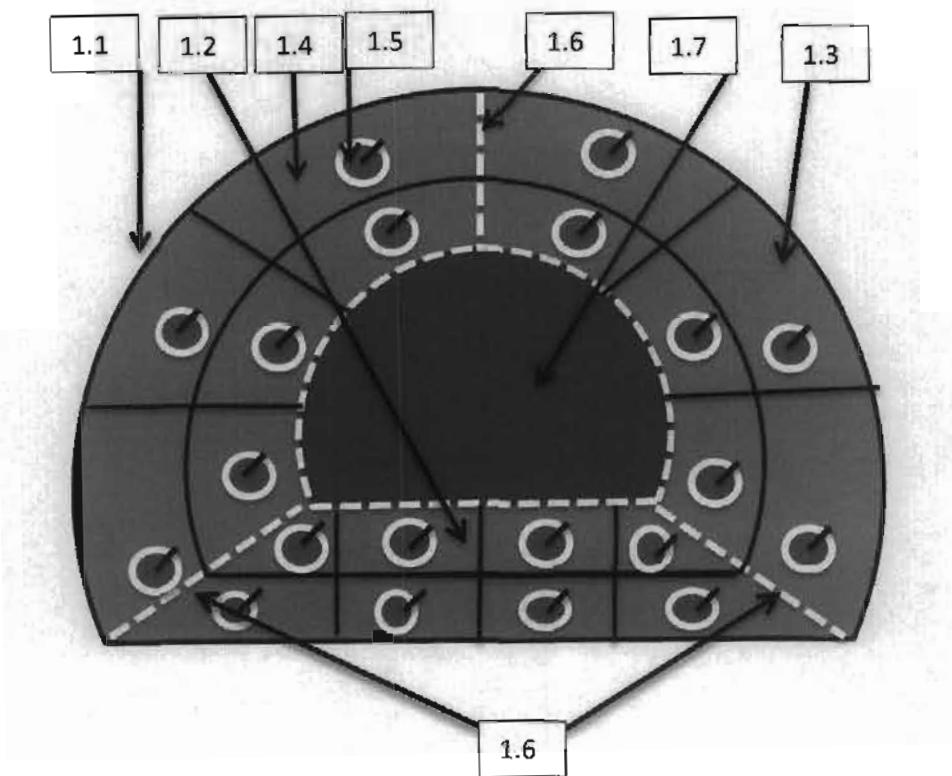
Element al sistemului de închidere rapidă a lucrărilor miniere subterane
